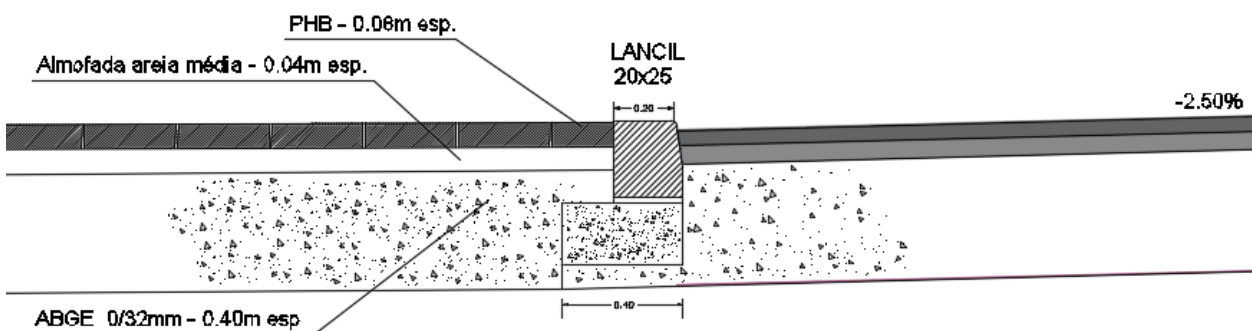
Pormenor de um lancil de granito rebaixado
